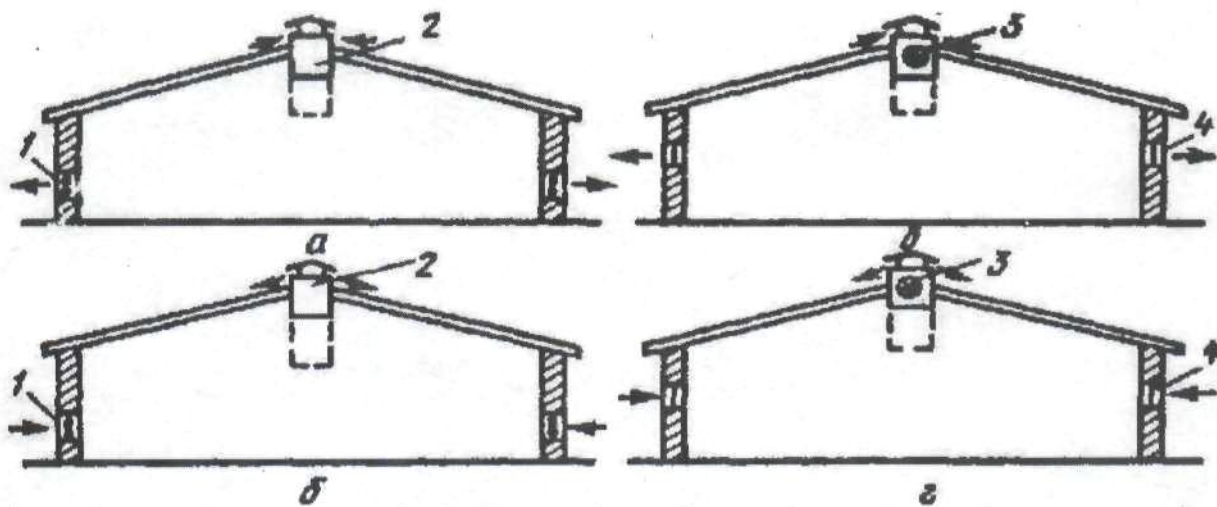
Основные типы летней вентиляции животноводческих помещений: а - вытяжная с настенными вентиляторами; б — приточная с настенными вентиляторами; в - приточная с крышными вентиляторами; г - вытяжная с
